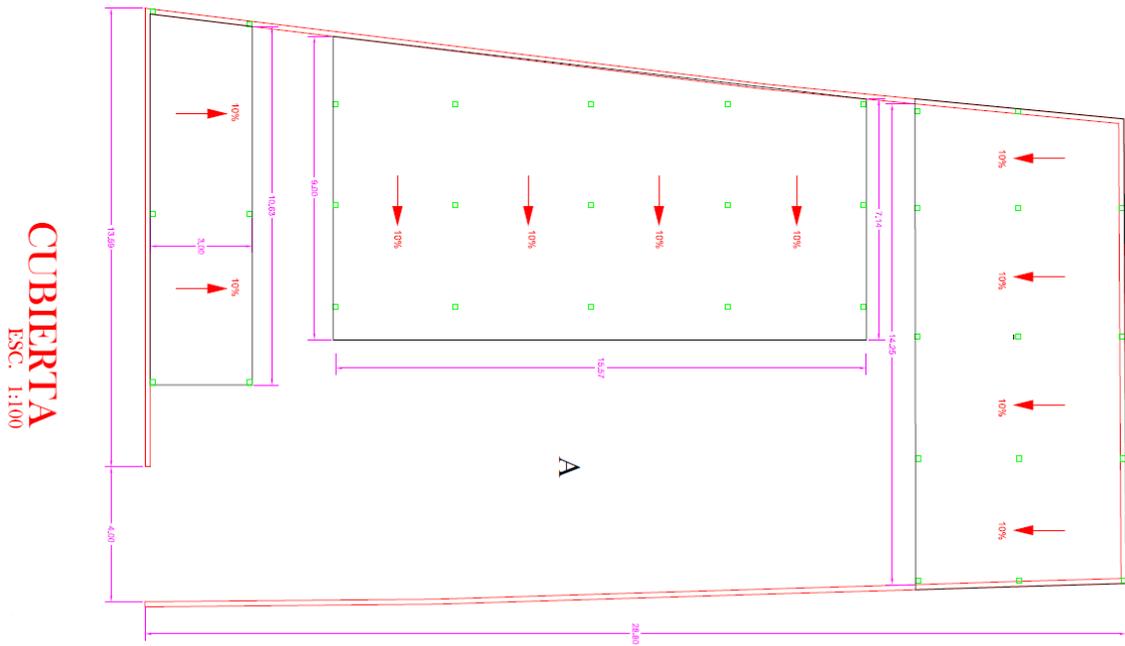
Plano de cubierta, descripción de diseño de cubiertas del centro de auto lavado.
